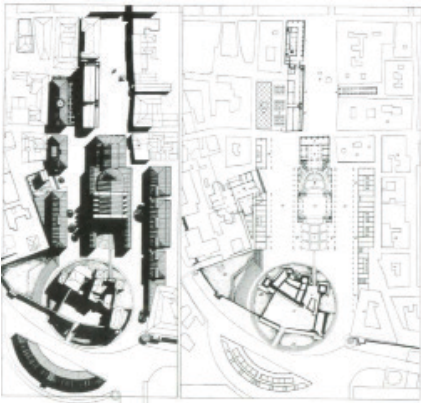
Planivolumetrico e planimetria del progetto Natalini per la riqualificazione di piazza Malatesta e la ricostruzione del teatro Galli ad essa prospiciente. Immagine tratta da: De Santi 2008, p. 147.
